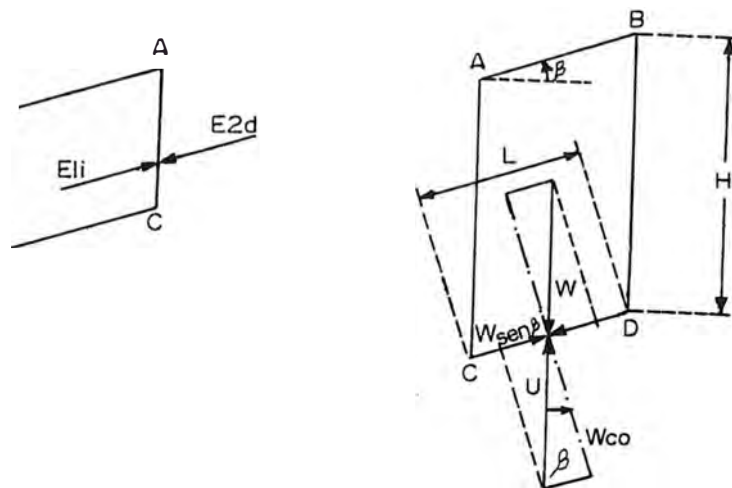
Talud indefinido con deslizamiento plano.
